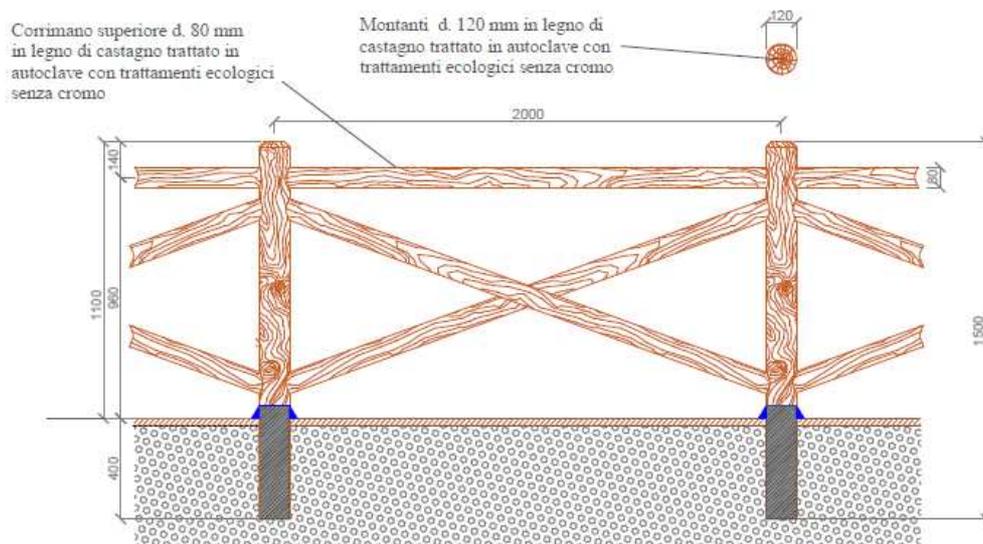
Particolare parapetto a croce su muro di sostegno tratta 3
